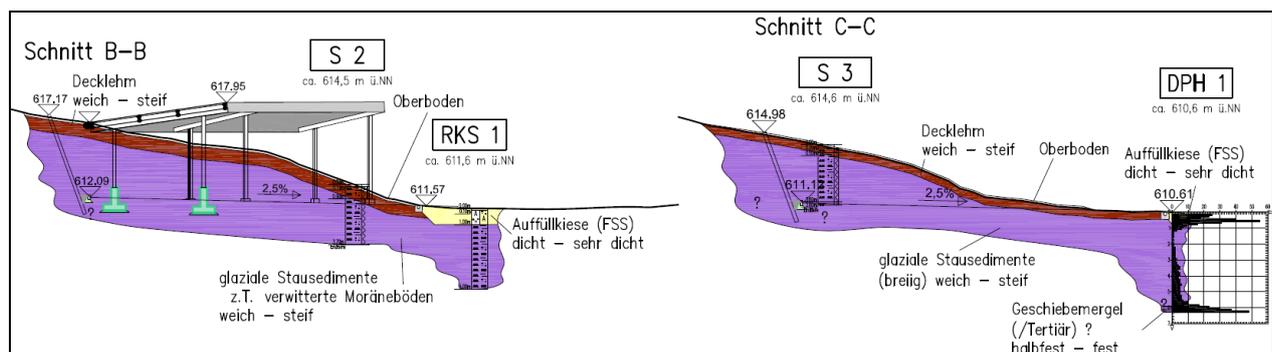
Schnitte aus dem Baugrundgutachten (Quelle IB Gebauer 2020, Anlage 5)
